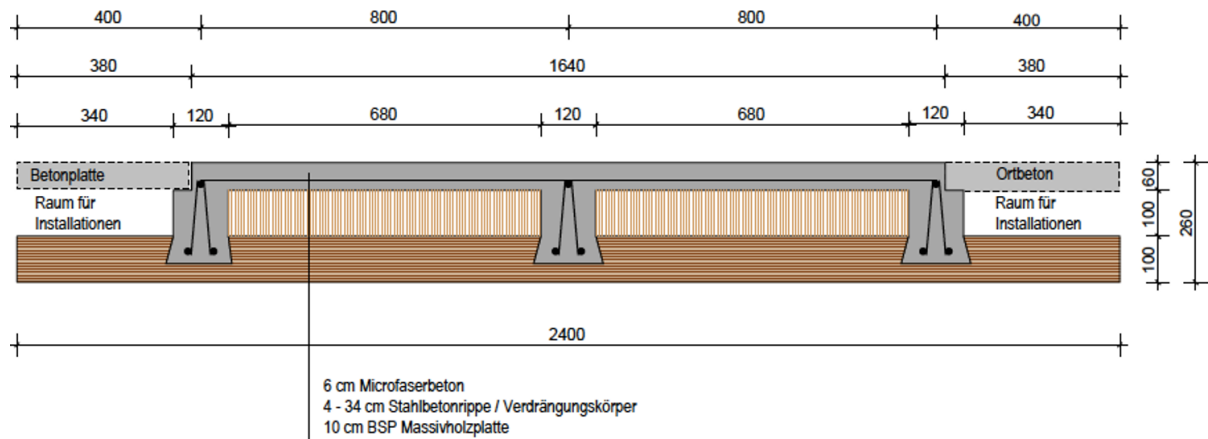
Regeldeckenkonstruktion bzw. Regelquerschnitt einer LIGNOTON® Brettsperrholz-Beton-Verbund Dielendecke als Fertigteil mit der Möglichkeit des gezielten Einbaues von Installationen innerhalb der Tragkonstruktion [6]
